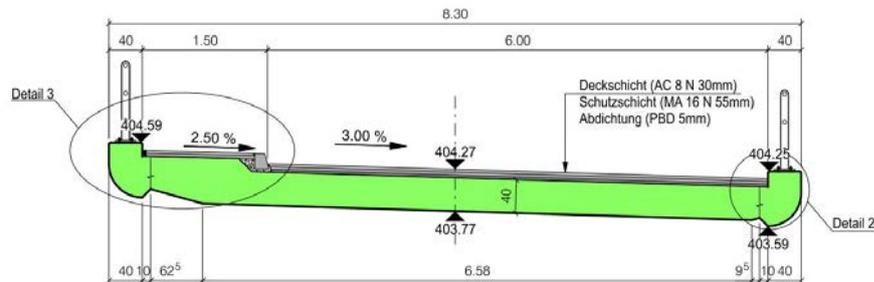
Querschnitt Brücke Rheinstrasse, Littenbach
